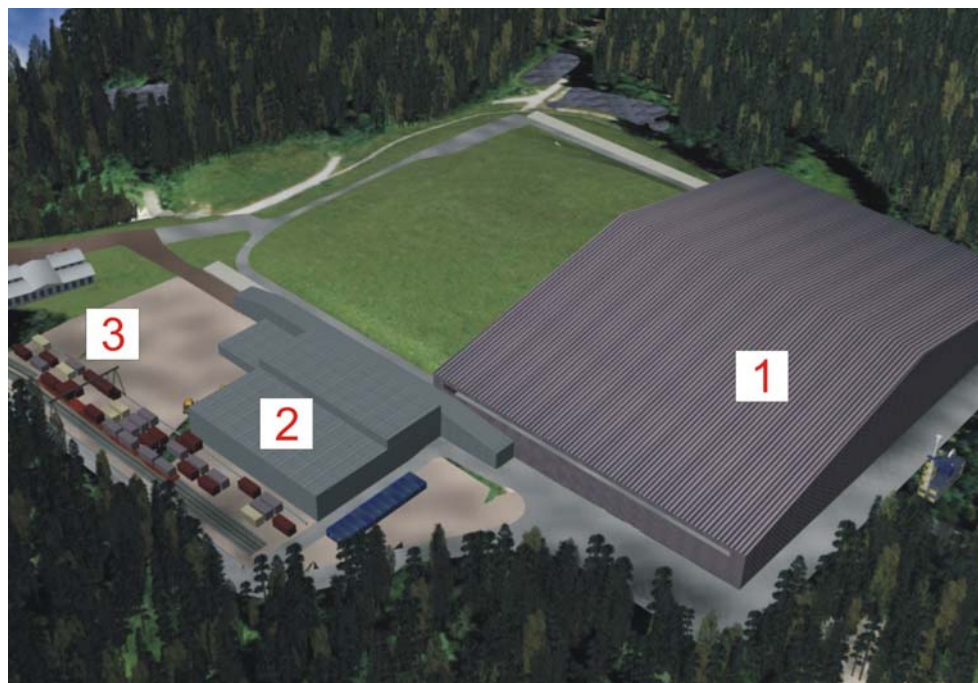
Infrastructures nécessaires à l'assainissement (1 : halle d'excavation; 2 : halle de conditionnement; 3 : place de transbordement)
